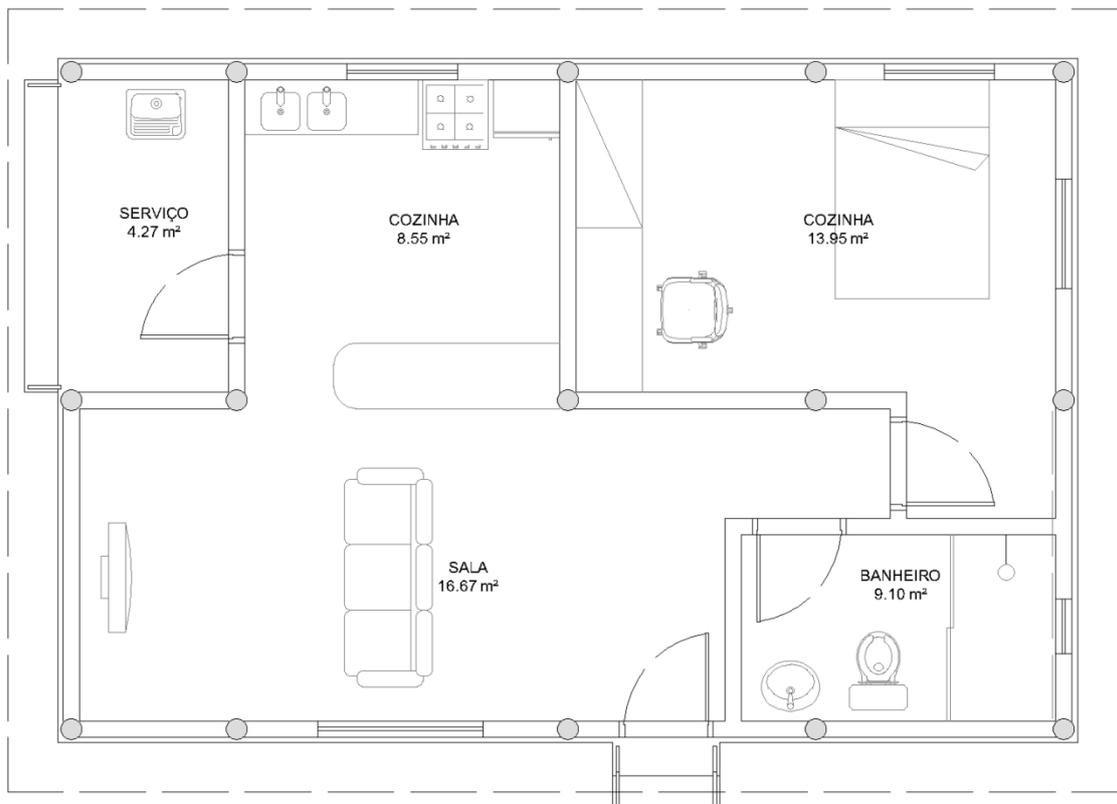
Planta baixa de layout habitação modelo em bioconstrução.
